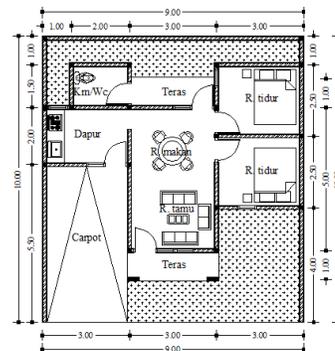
Site Plan Perumahan Permata Biru Purbayan (setelah direncanakan kembali)
